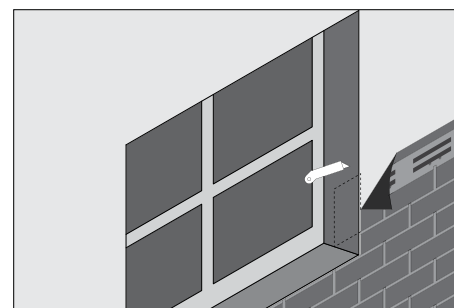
Монтаж фасадной плитки вокруг оконных проемов
